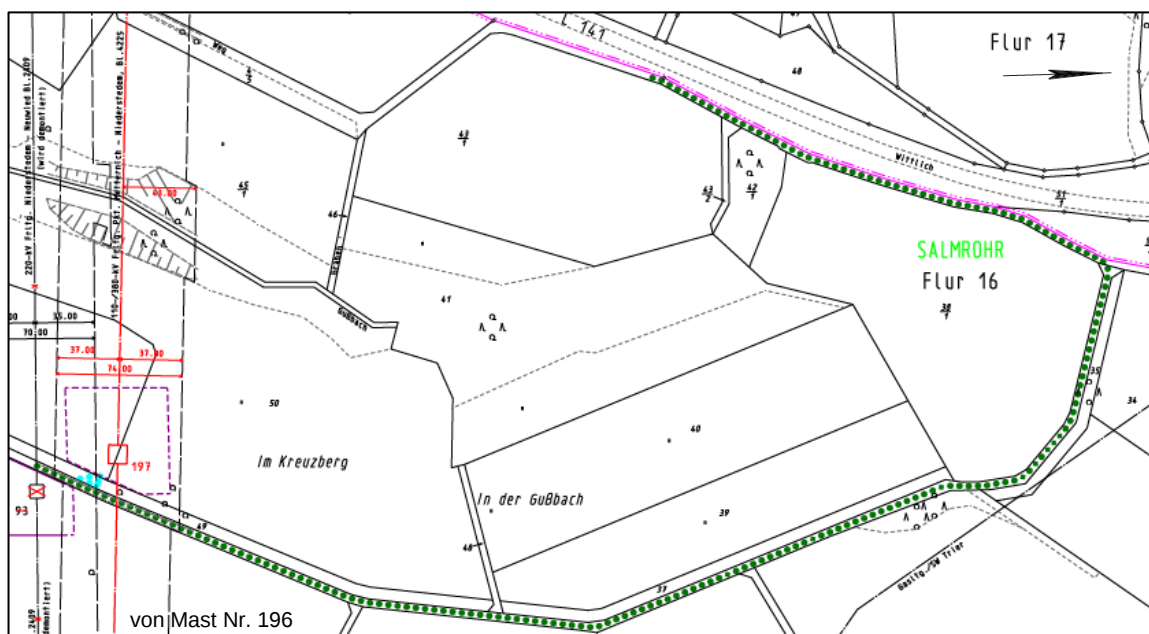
Lageplanausschnitt der Erweiterung der Zuwegung zu Mast Nr. 197.
